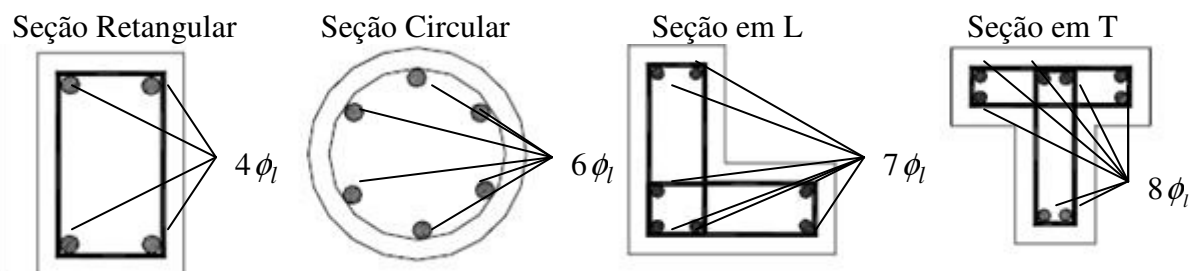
Número mínimo de barras longitudinais (SCADELAI e PINHEIRO, 2005)
